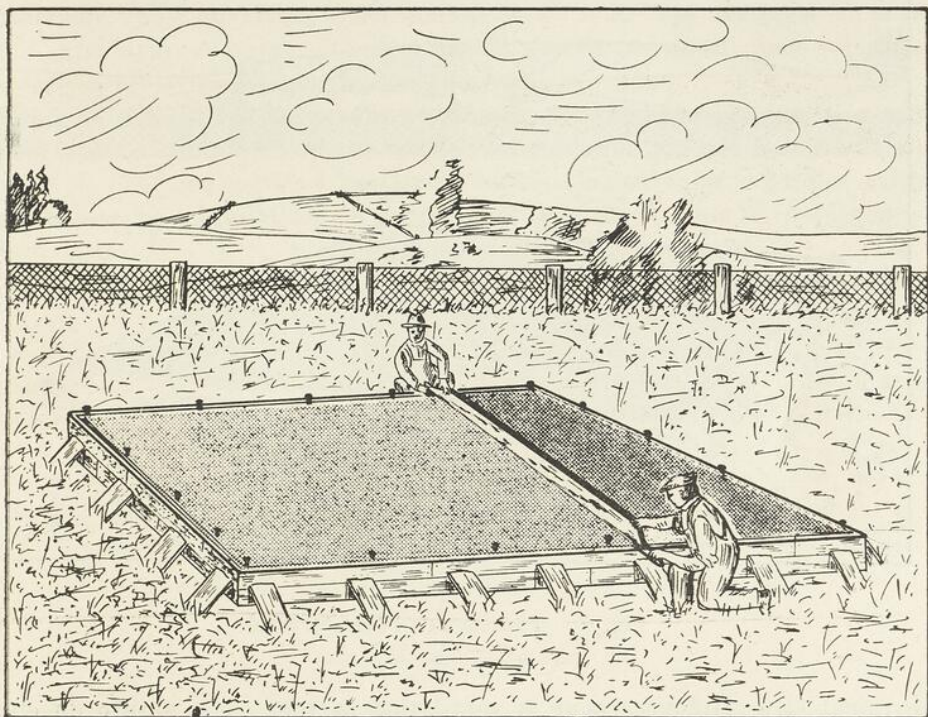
Construction du plancher en béton.—Lorsqu'on fait un plancher en ciment, il n'est pas nécessaire de faire des fondations. On commence par faire un cadre avec des planches emboutées d'un pouce d'épaisseur, et de dix à douze pouces de hauteur. Ce cadre doit avoir les proportions du futur poulailler. On place ces planches sur le can et on les retient en place au moyen de piquets. On remplit alors le cadre de roches, vieilles briques, mortier, mâchefer, jusqu'à 2 pouces de la surface du bord du cadre, excepté un espace de quelques pouces pour la face extérieure du mur qui doit être en béton.
